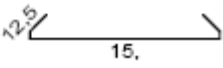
armaduras do banzo inferior do oitão segundo o projeto estrutural original
